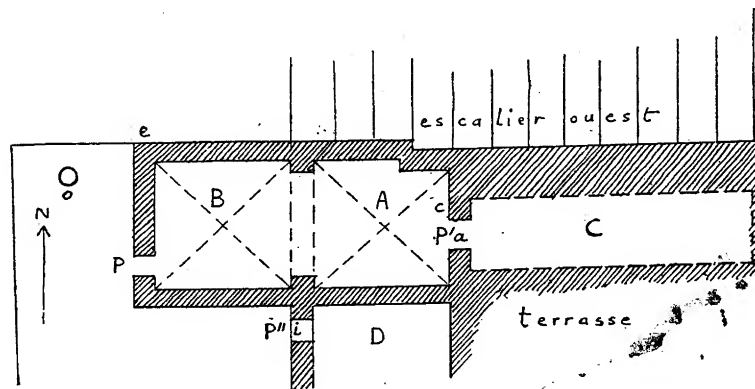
Plan de la citerne de Malik Mu'azzam.
